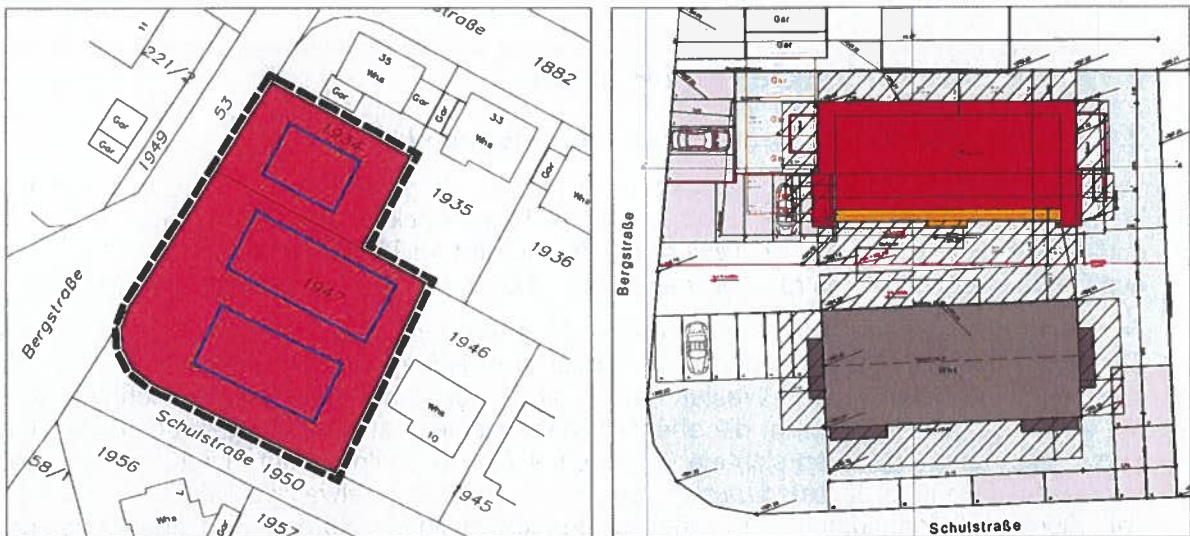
Geplanter Änderungsbereich des Bebauungsplans „Rathengraben, Klausenäcker, Gartenäcker“ (links; GANTER 2022) und Planung für den Bau eines Mehrfamilienhauses auf Flurstück 1947 (rechts, ARCHITEKTURBÜRO GEISER GMBH, 2022).
